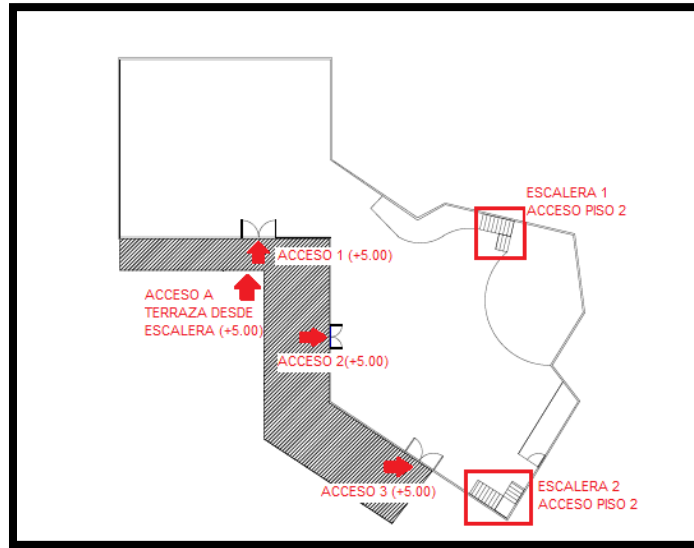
“Vista en planta de accesos y escaleras del piso principal (cota +5.00) de la discoteca 1.”
